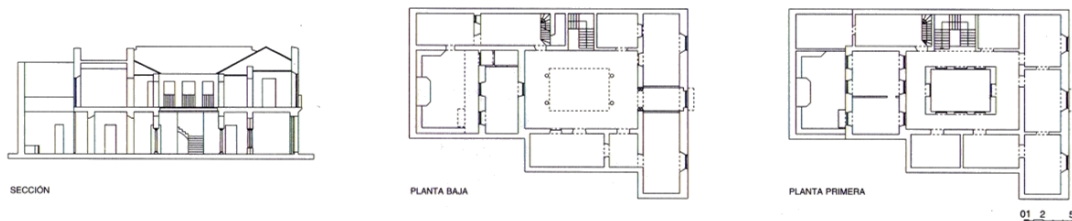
Sección, planta baja y planta primera, casa patio en Sevilla. Fuente: Libro La Casa Meridional.
